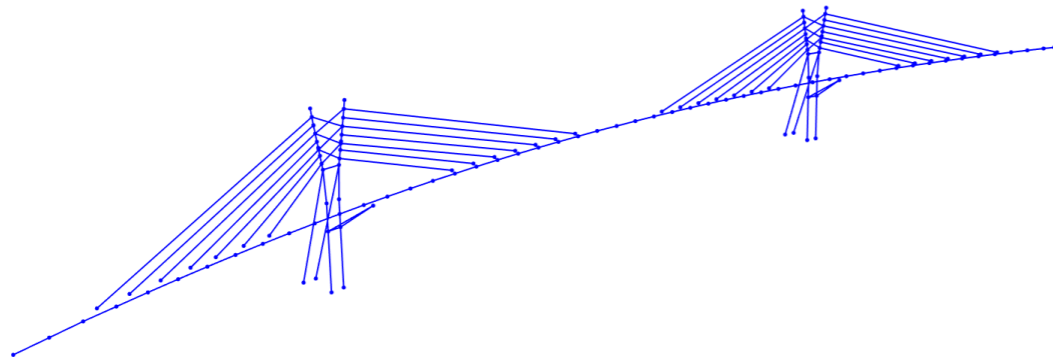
Geometría sin deformar de la estructura de la pasarela. Fuente: Elaboración Propia (SAP2000)
